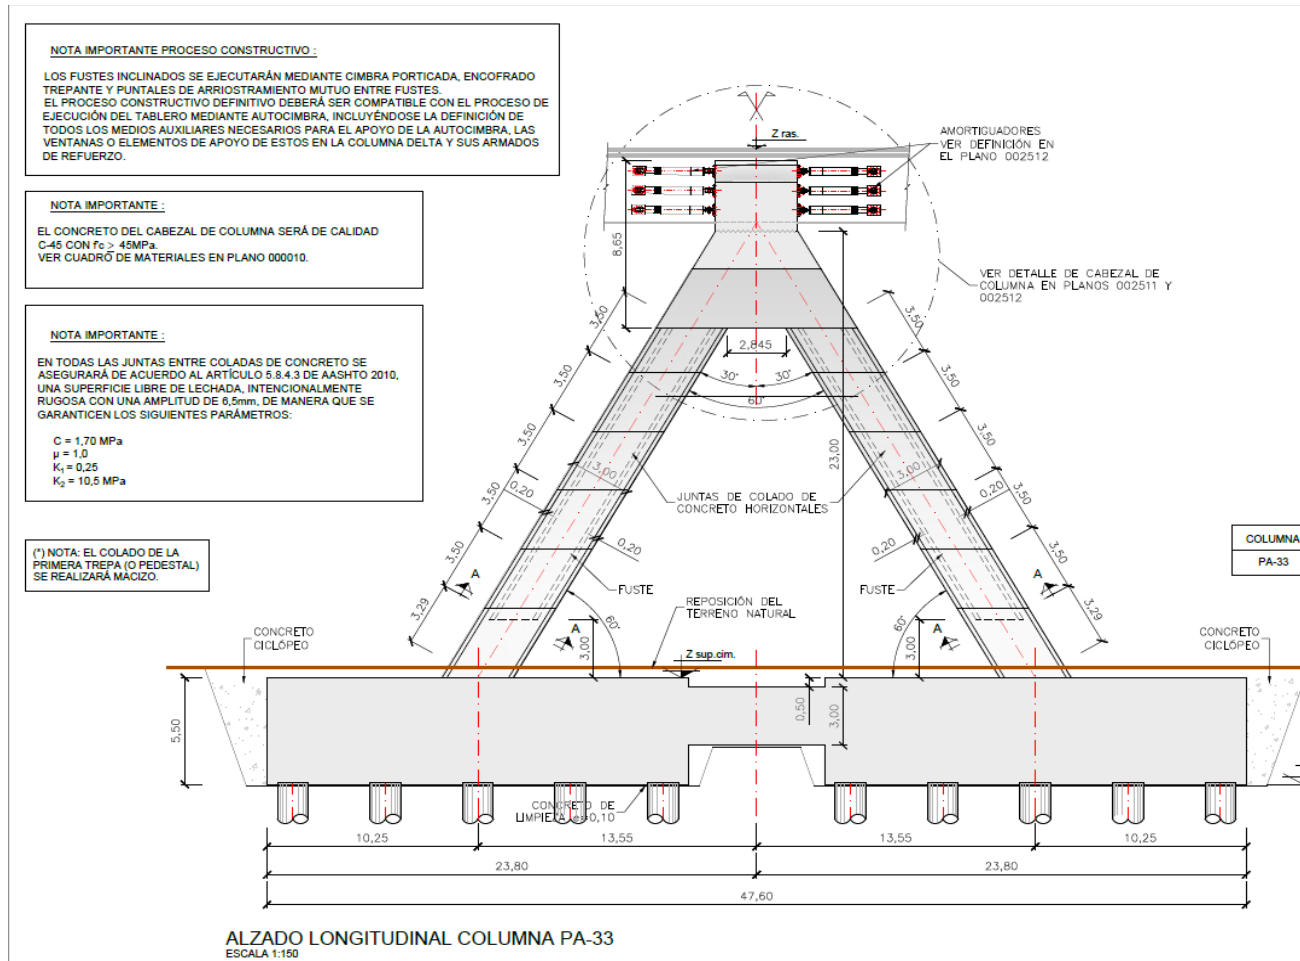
Alzado longitudinal de la columna tipo DELTA del apoyo P-33 (IDEAM, 2016).
